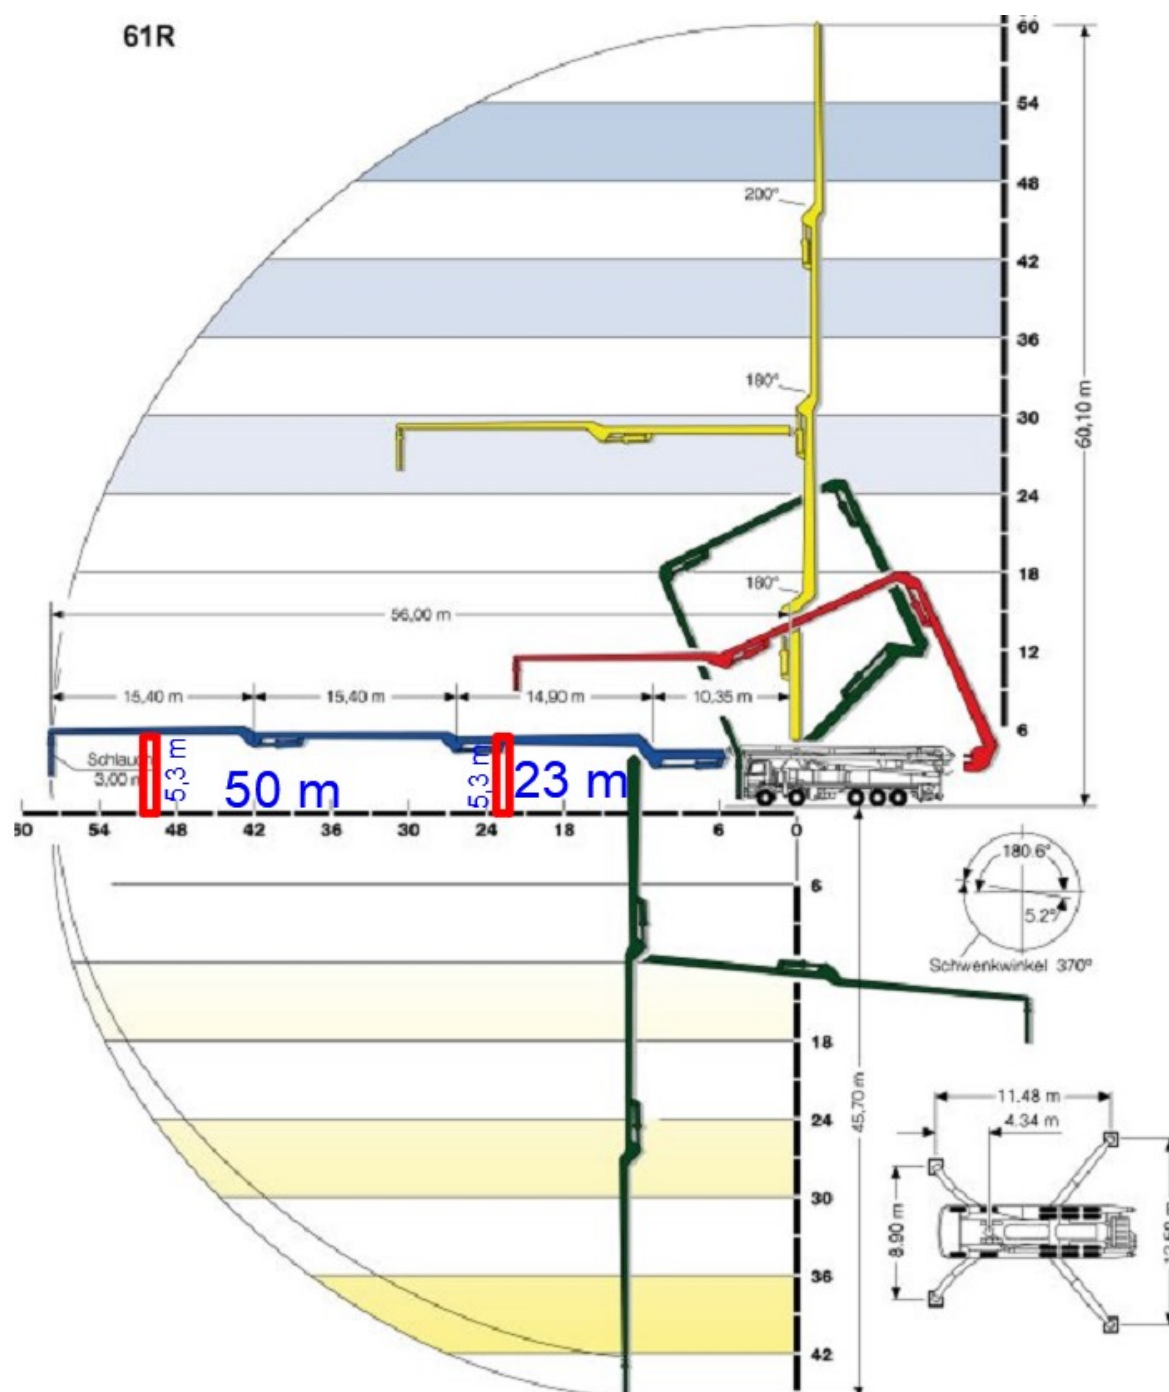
Auto-čerpadlo SCHWING [37]
